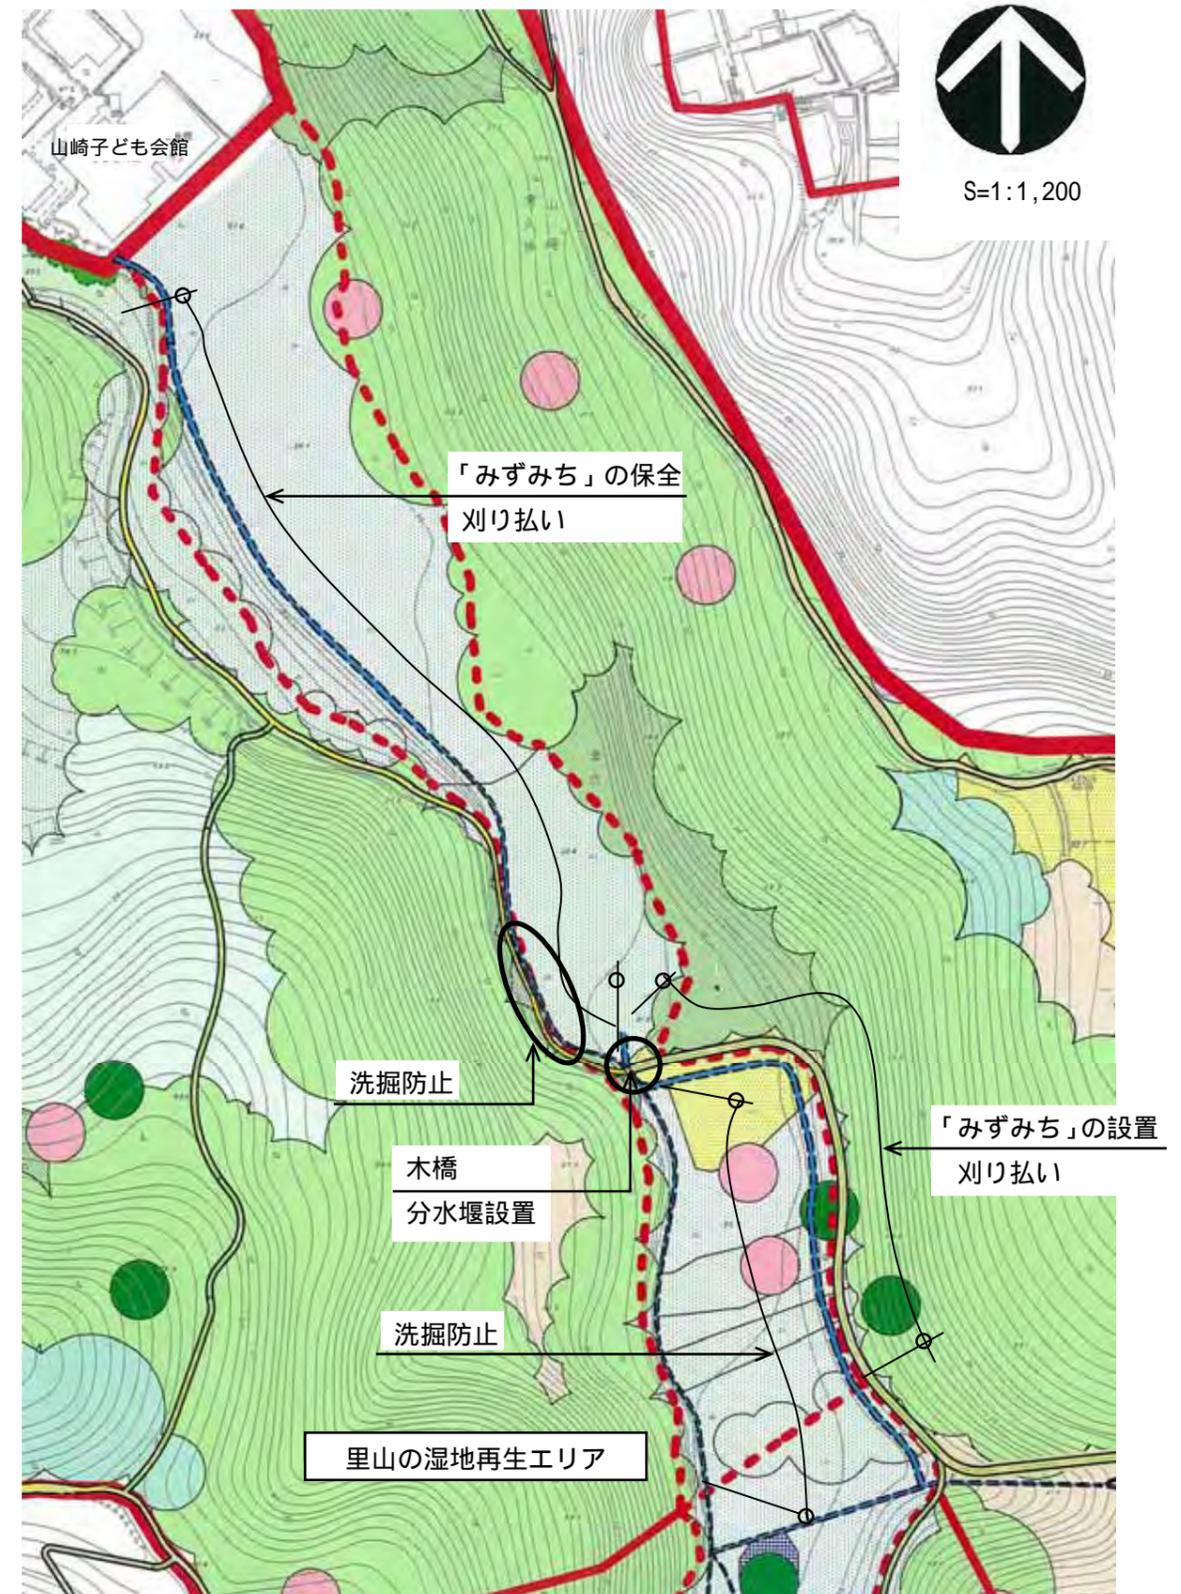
里山の湿地再生エリア 基盤整備平面図
